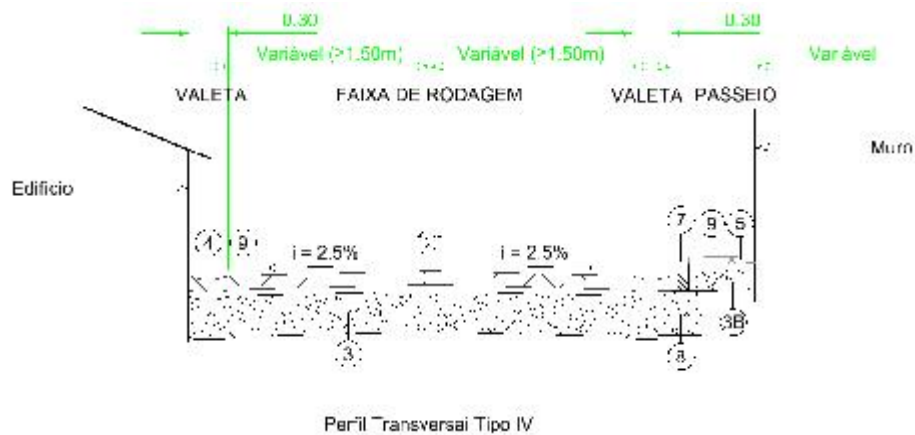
Perfil Transversal Tipo IV (Rua Vieira de Leiria)
